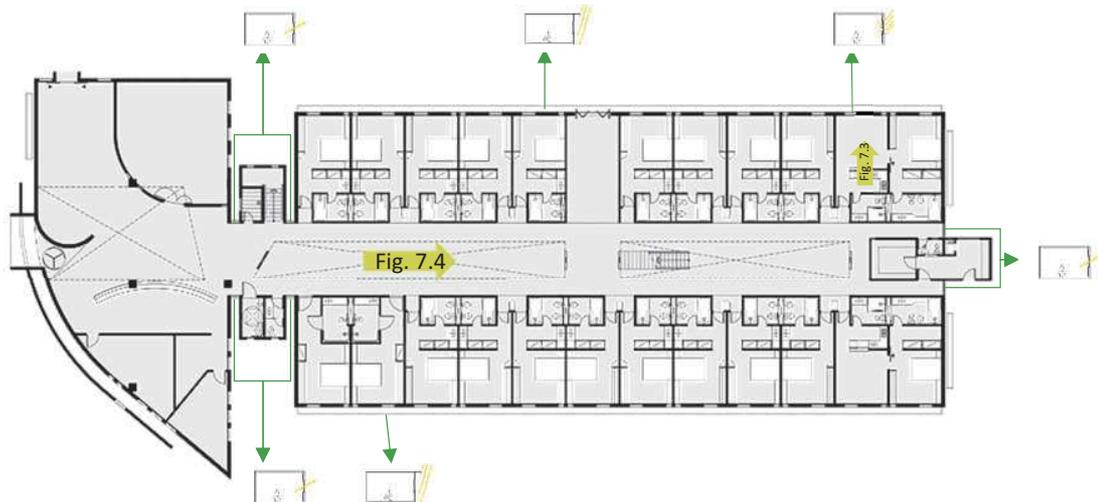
Planta Térreo – CPV. Fonte: Arquivos Bloch Arquitetos.
